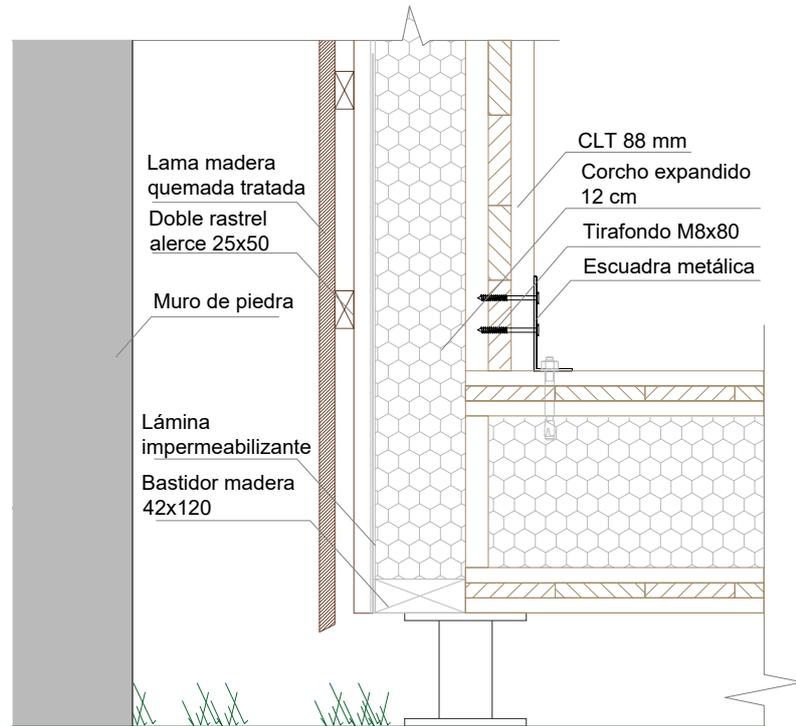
Detalle constructivo. Solución 1. Fuente: Elaboración propia
